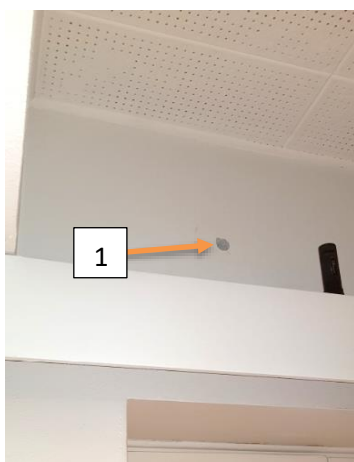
ja 19. Rakenneavaus sattui tuuletussäleikön kohdalle.
